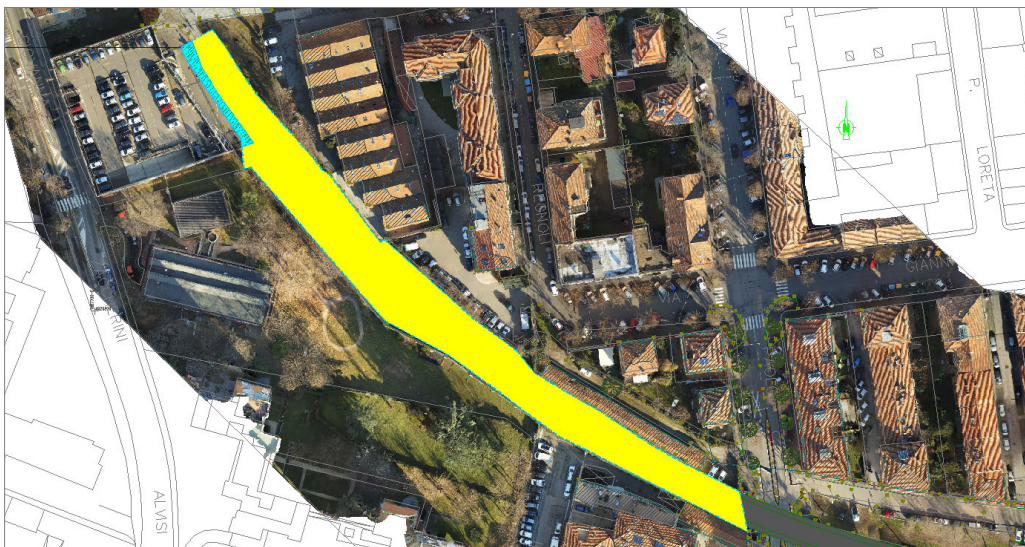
Area di cantiere tratto San Vitale-Via Fabbri.
